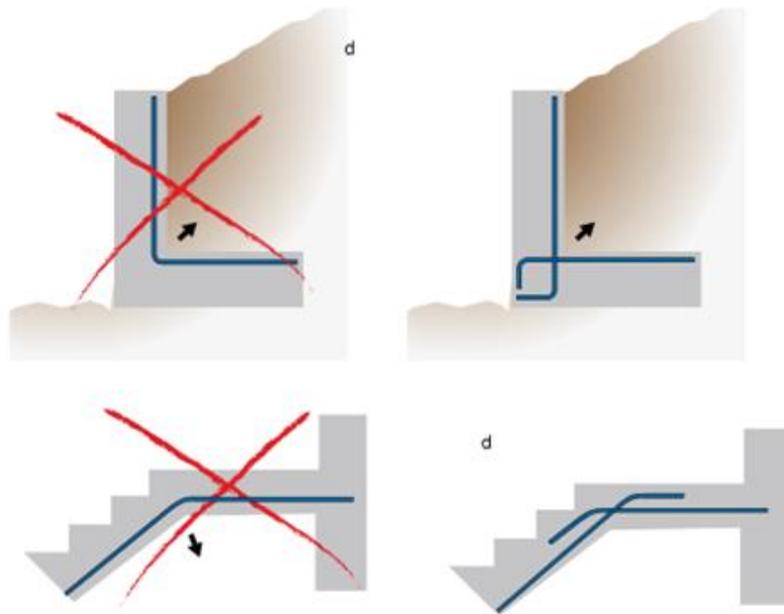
exemples de poussée au vide d'armatures tendues et solution alternative [18]
